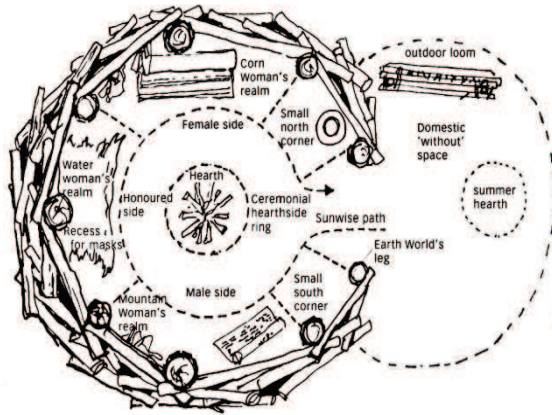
Grundriss mit Raumaufteilung Corbeled-log-Roof-Hogan
